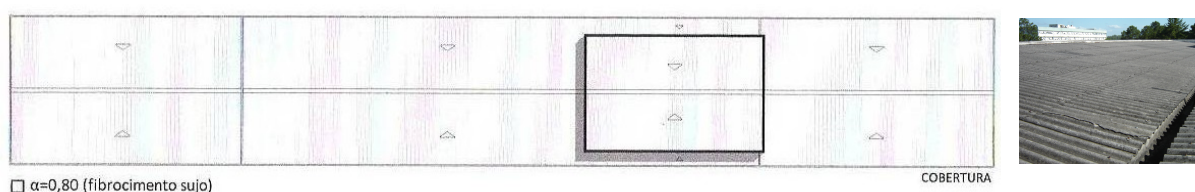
Planta da cobertura e aspecto da telha de fibrocimento
